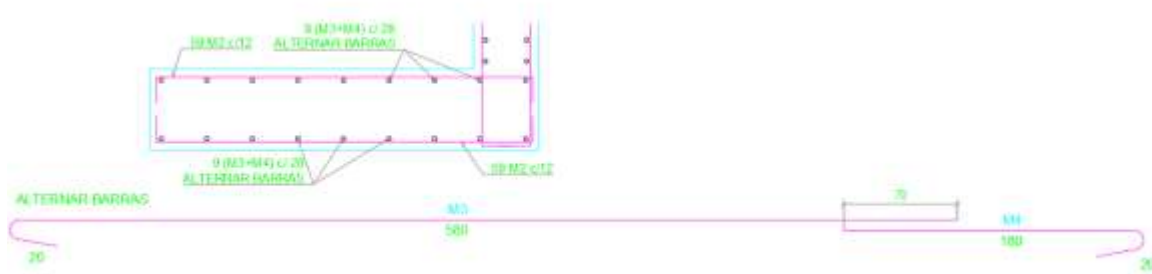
sección 2 muro anclado 2 alto viento, fuente propia.
